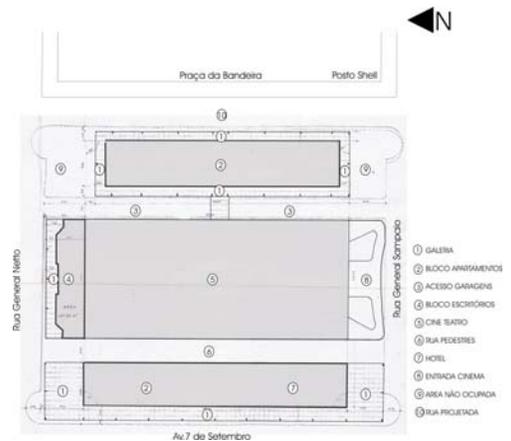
Cine Hotel Consórcio. Planta de Situação.
